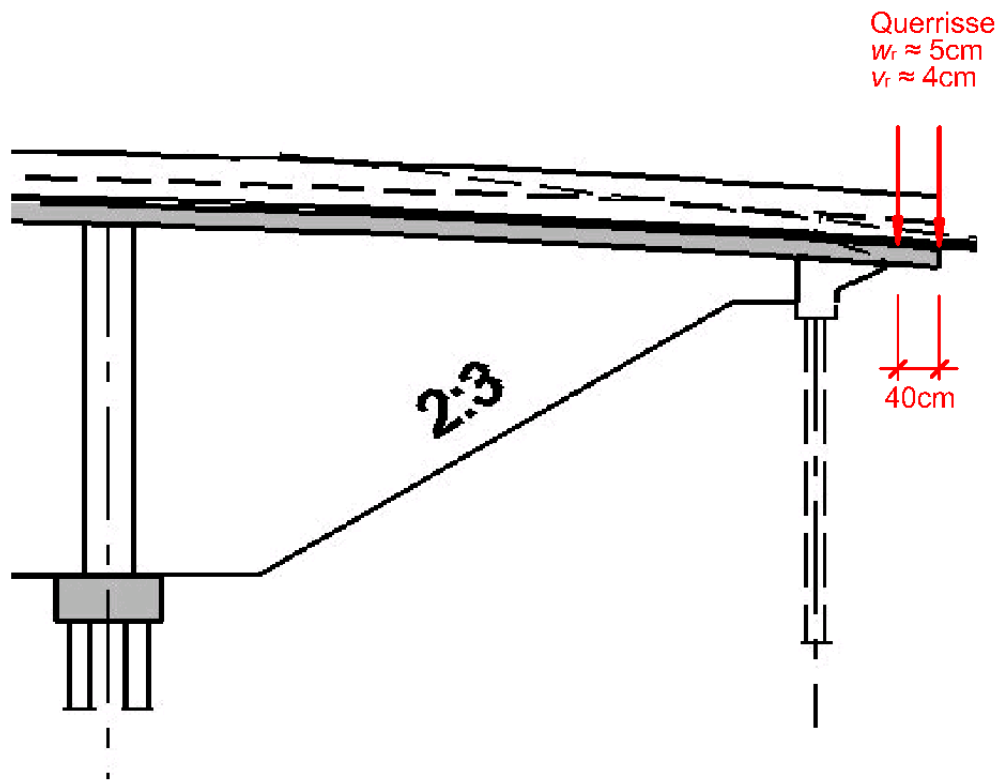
Belagsschäden rechtes Brückenende BS 12 UEF Grienstrasse, Pieterlen
